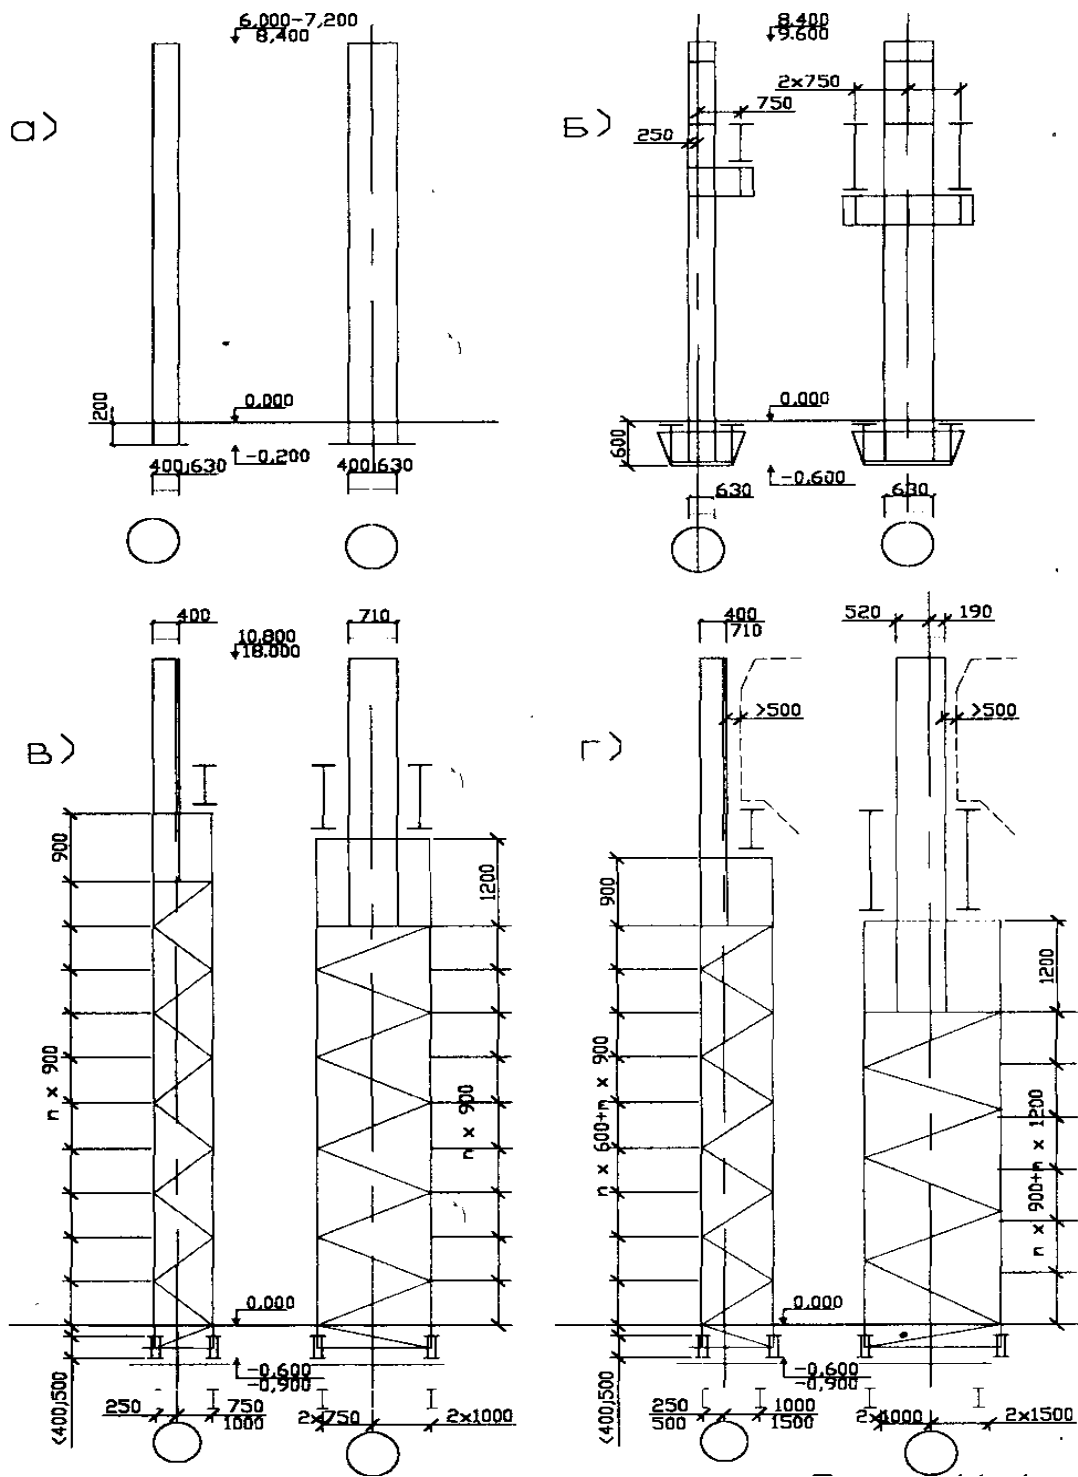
Типы стальных колонн одноэтажных промышленных зданий:
